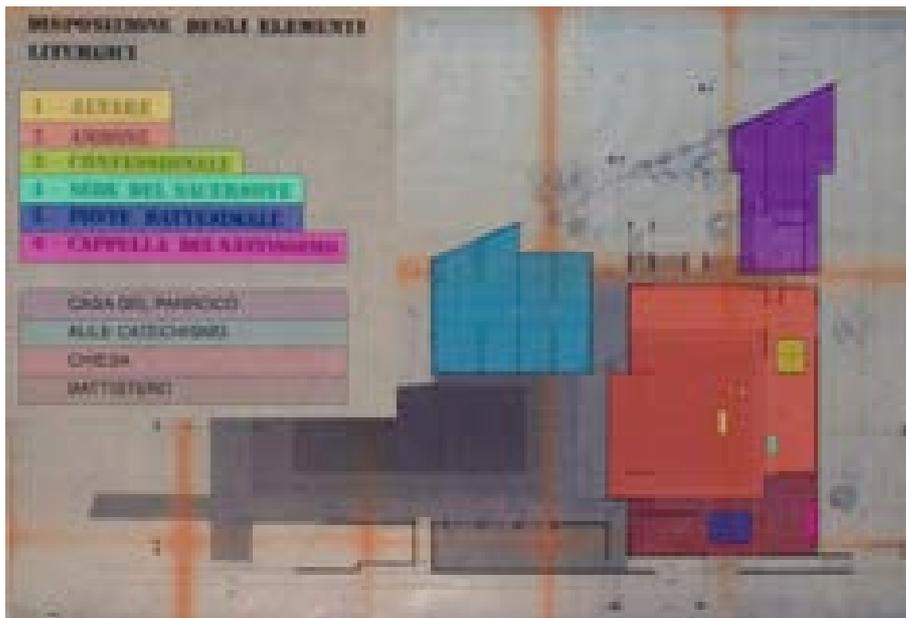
Rielaborazione pianta +2.80 – 15/01/1977 (AABS-1996.695)
